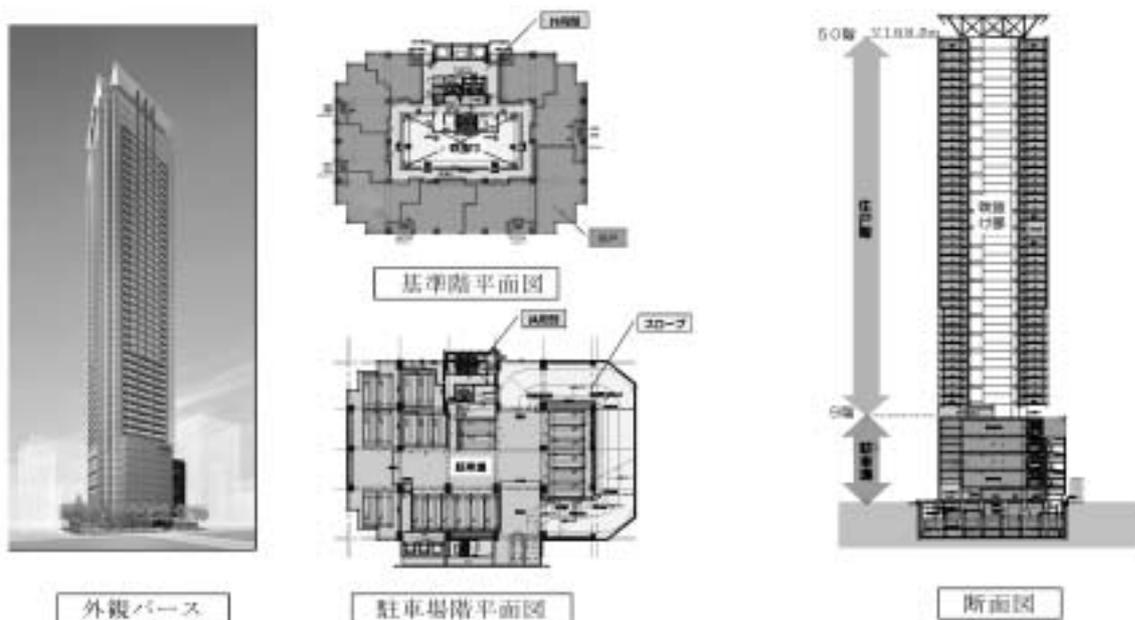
外観パース、基準階平面図、駐車場階平面図、断面図
